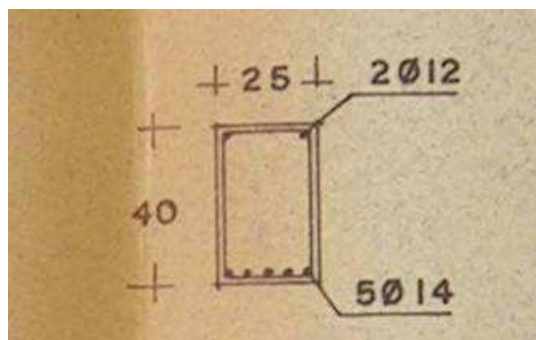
Detalle de armado de viga. Edificio ficha 88C.019, 1966.
